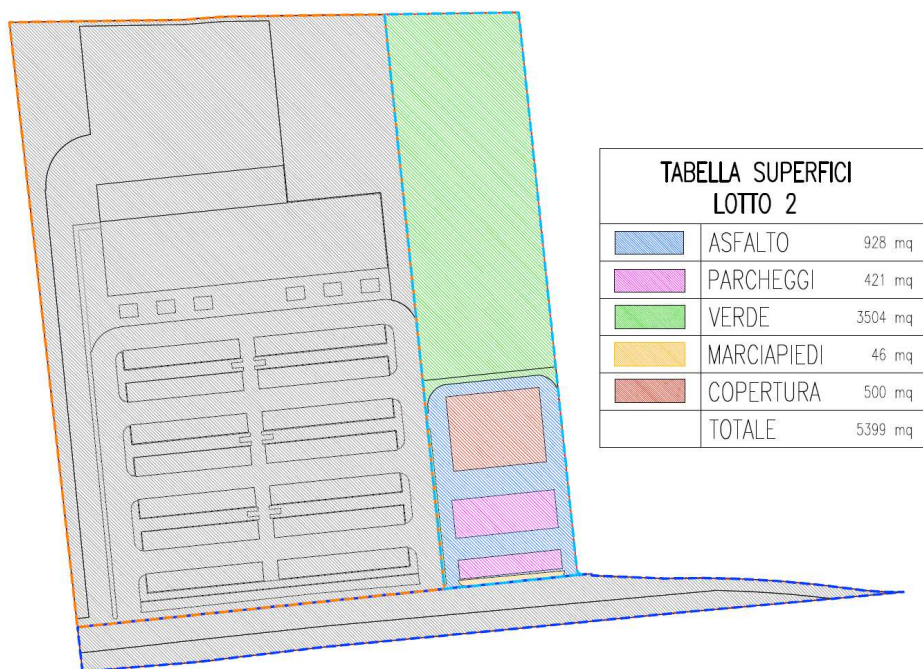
SUDDIVISIONE DELLE DESTINAZIONE D'USO ALLO STATO DI PROGETTO – LOTTO 2
